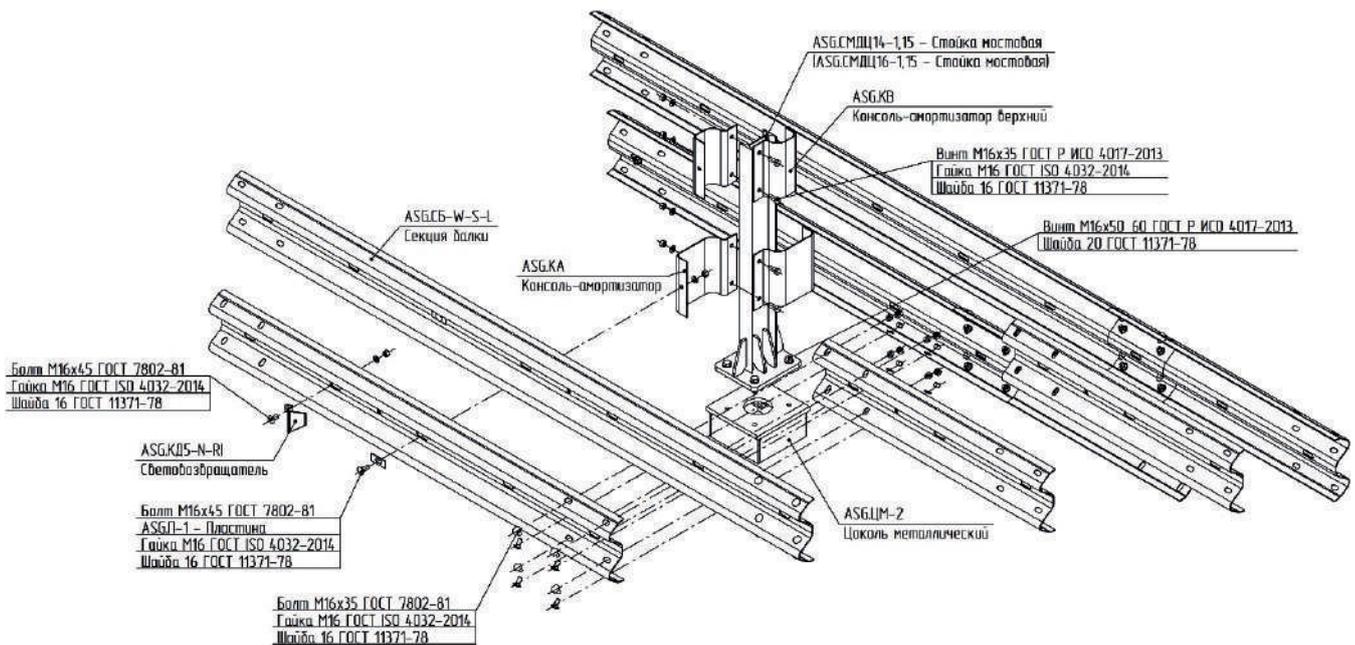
Схема сборки конструкций №42 и №43
